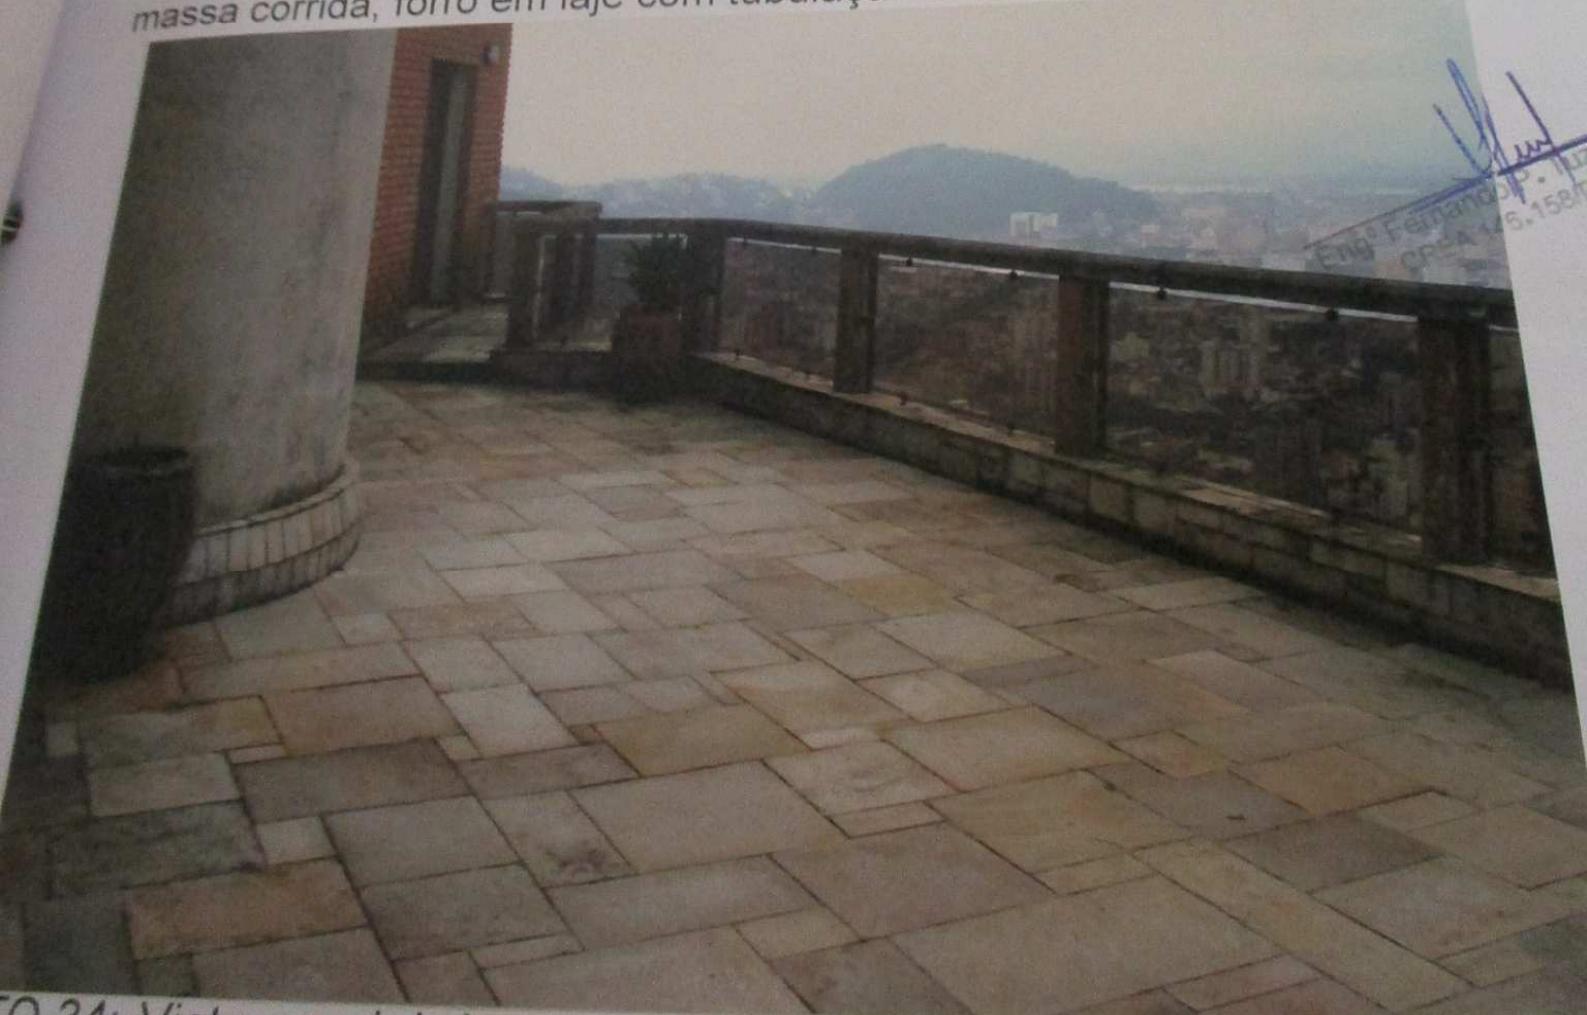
Vista parcial da varanda / terraço da sala íntima do pavimento superior; o piso é revestido com pedras “goiás”.
